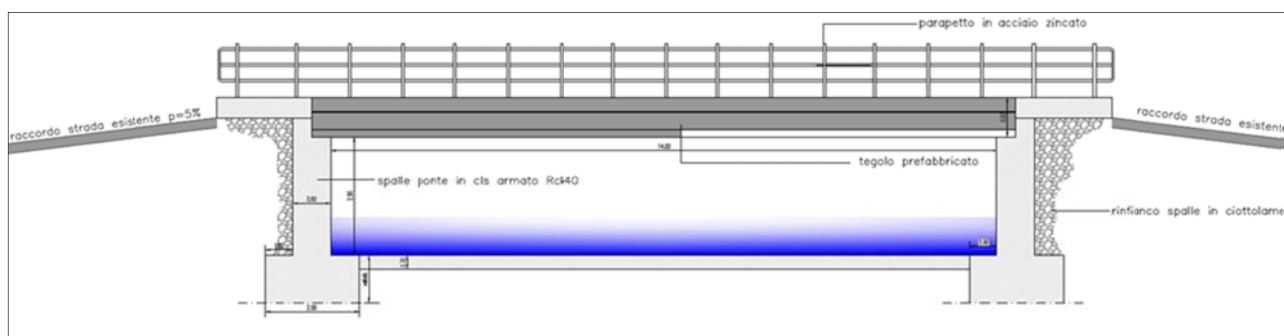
Schema ponte tipo attraversamenti sul rio Saoru
